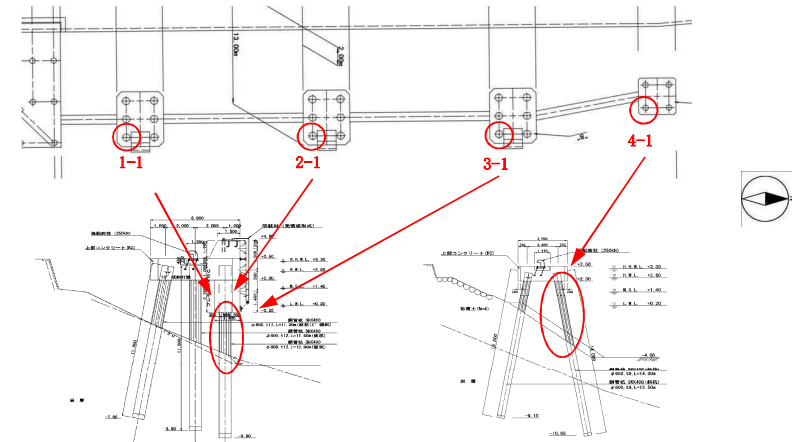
ドルフィン 平面・横断面図 (下部工：海水面より下)
